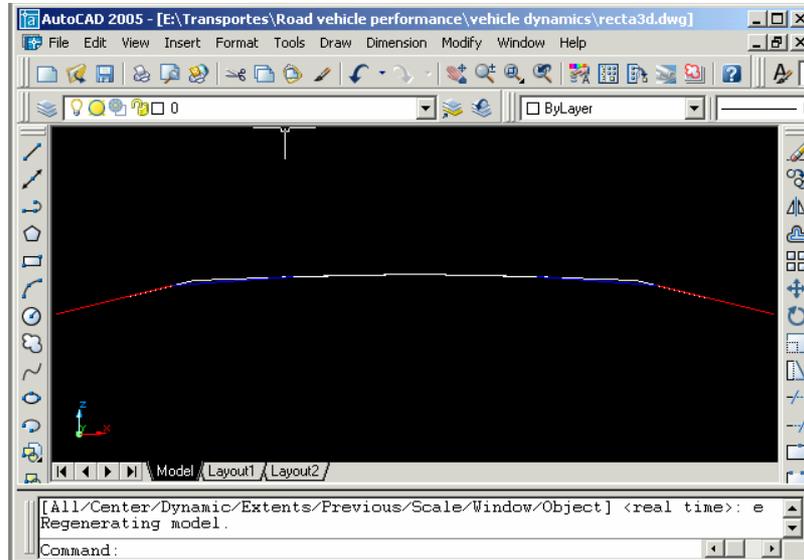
Diseño del perfil del camino en 2 dimensiones
